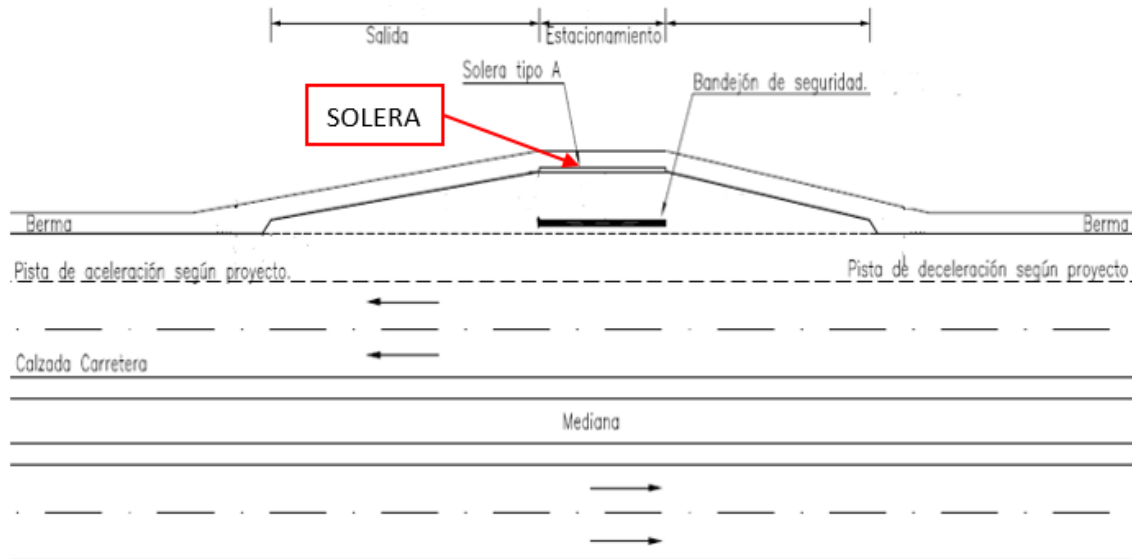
Vista en planta sector paradero de buses y su elemento accesorio a valorizar.
